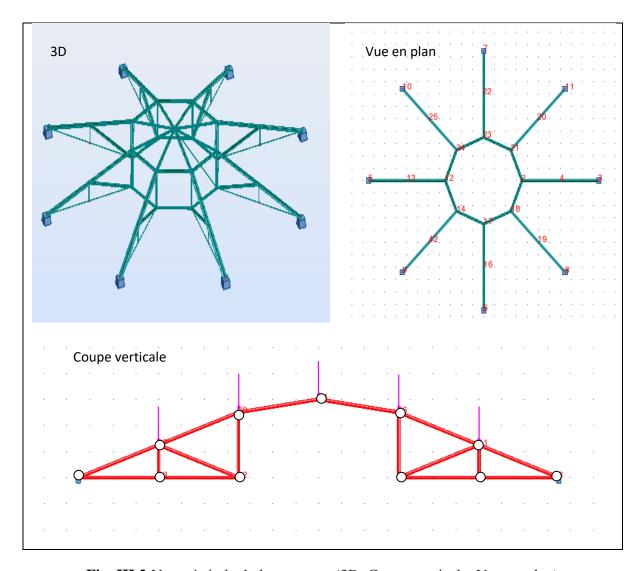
Vue générale de la structure (3D, Coupe verticale, Vue en plan)
